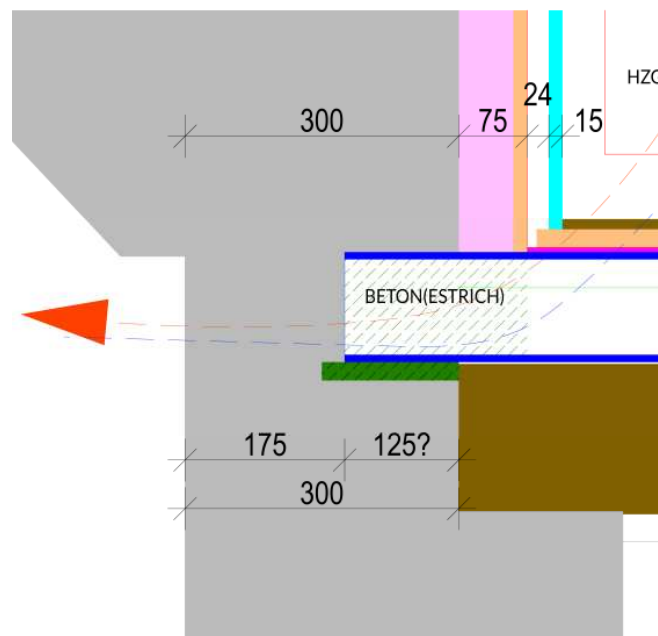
Untersuchter Bauteilaufbau – Trägerkopf (o.M.)
